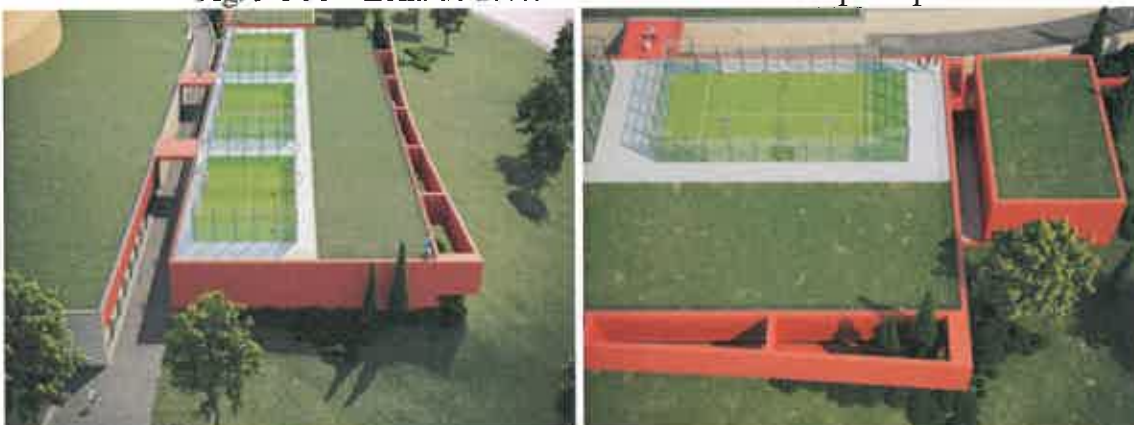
e 12 – Vista Panorâmica dos campos exteriores
